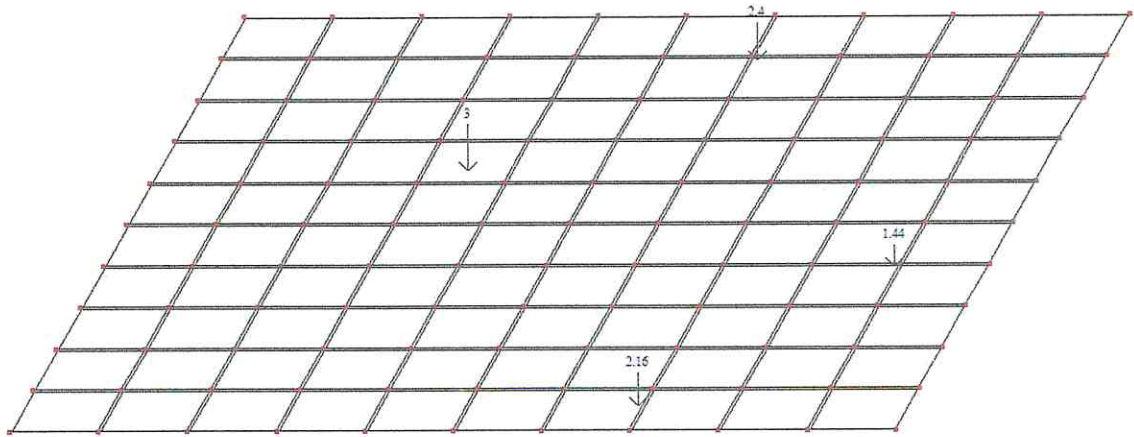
Нагрузки на плиту перекрытия шахты от лифтового оборудования.
